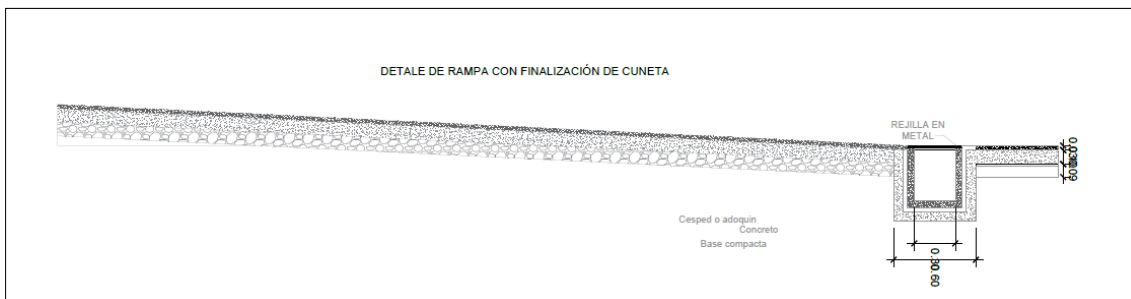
, Detalle constructivo de la rampa en la vía peatonal.
